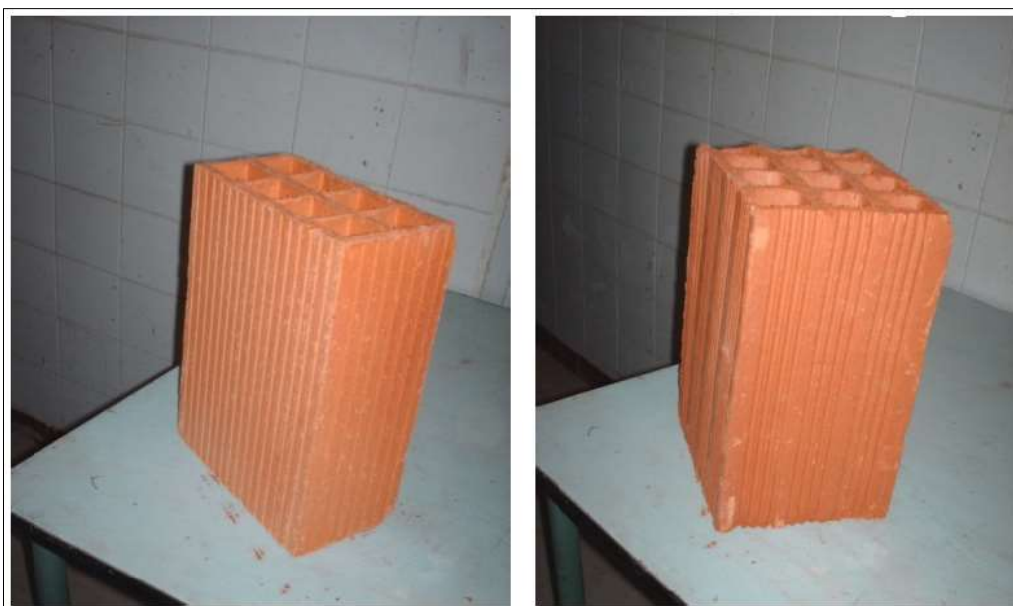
Brique creuse en terre cuite de 8 et 12 trous sans enduit en ciment
